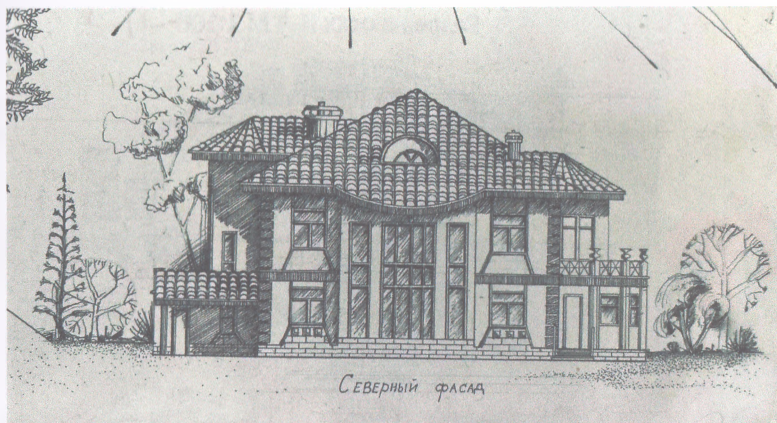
Фасады жилого дома (фрагмент проекта студента гр. ДАС-3-14 Эсеновой Айканыш)
